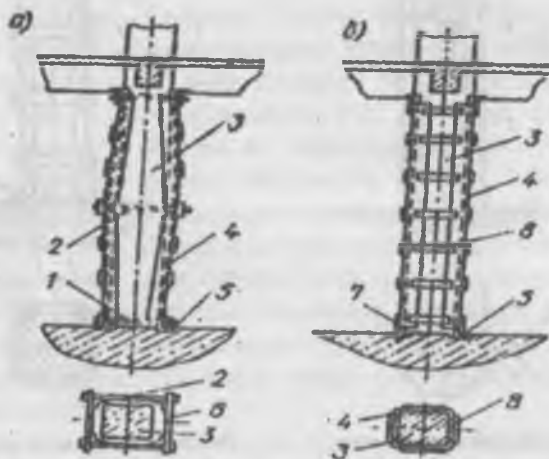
Усиление колонны предварительно напряженными двухсторонними металлическими распорками:
